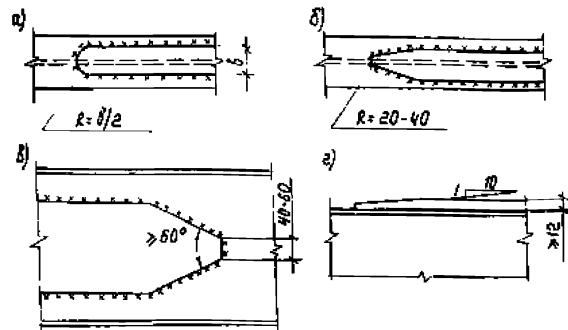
Форма наладочных листов присоединяемых на сварке
